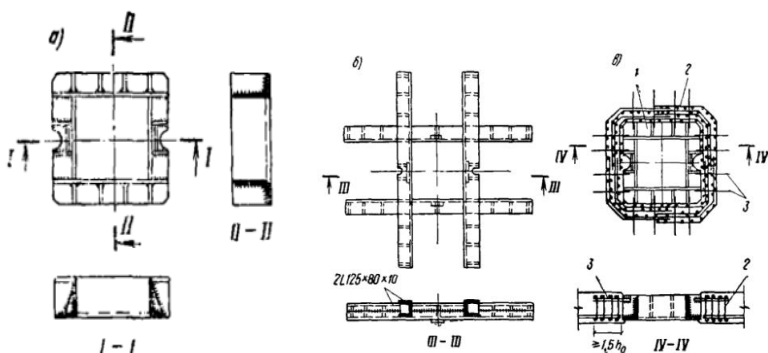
Примеры конструкций стальных воротников: а – короткий воротник; б – длинный воротник; в – воротник с поперечной арматурой; 1 – воротник; 2 – сваренные каркасы с поперечной арматурой; 3 – анкерные стержни
